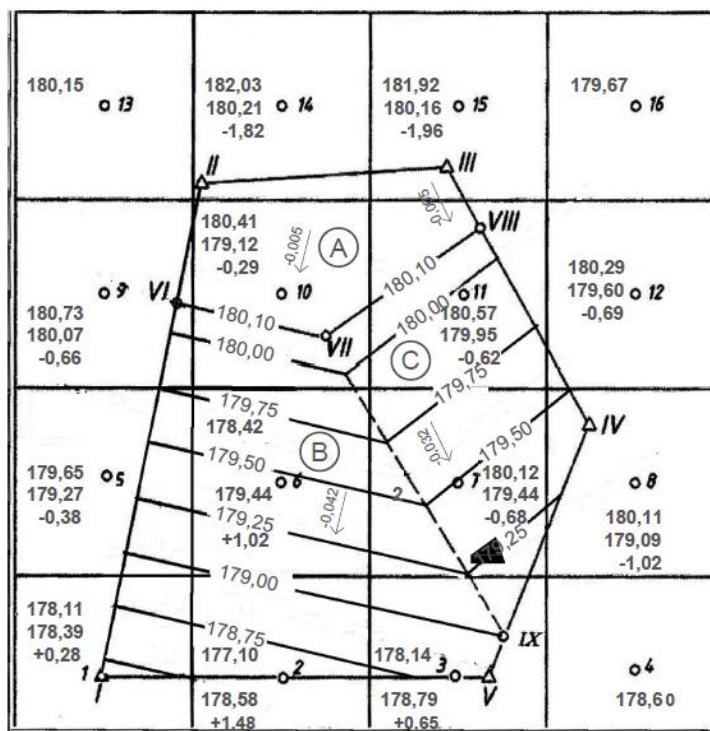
Оптимальный план вертикальной планировки при: :
